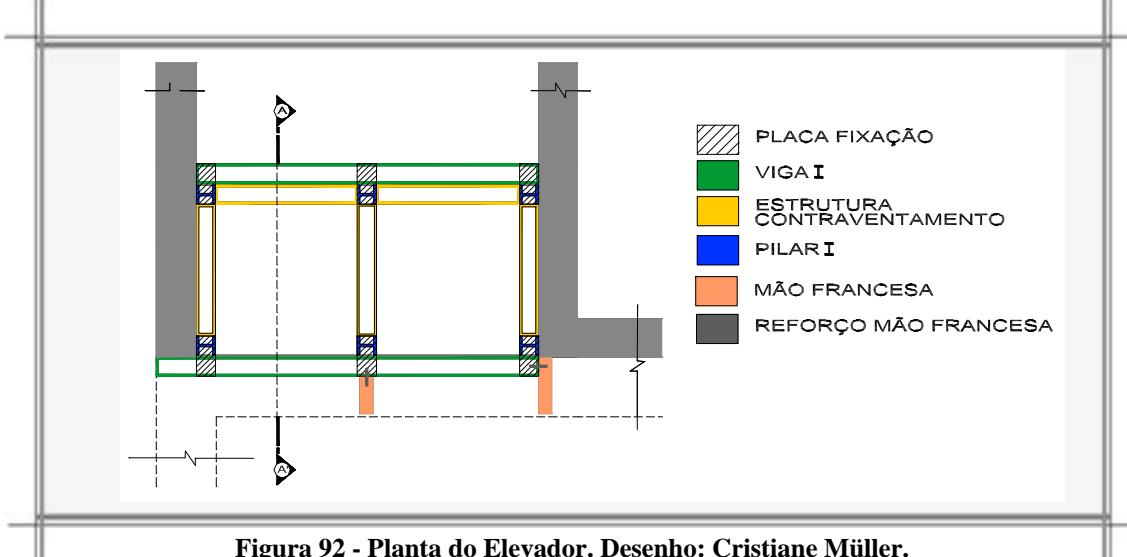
Planta do Elevador. Desenho: Cristiane Müller.
